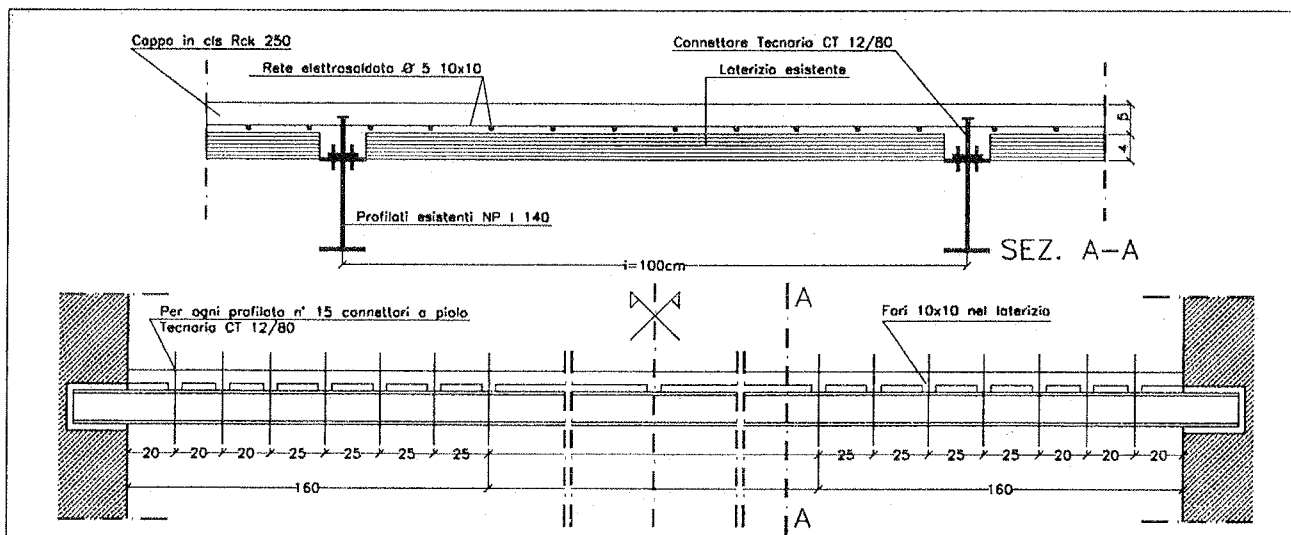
Il rinforzo dei solai in laterizio e profilati di acciaio
